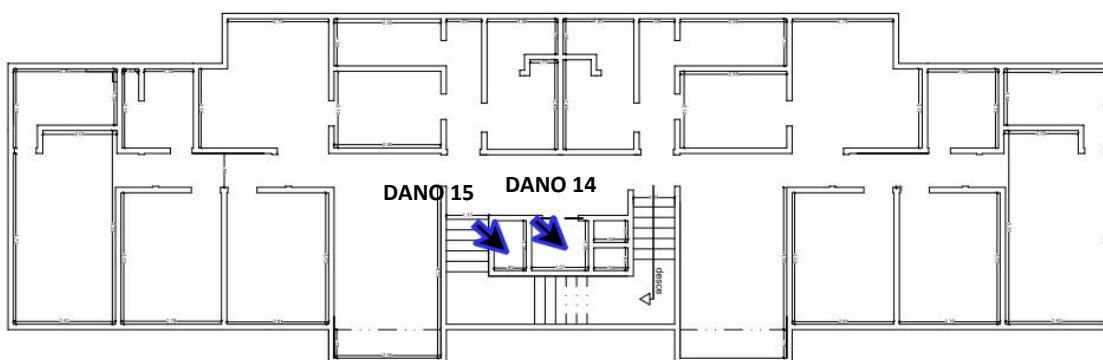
Planta Baixa (croqui) do Pavimento do 6º andar – Bloco A –Cond. Armando Lôbo.
